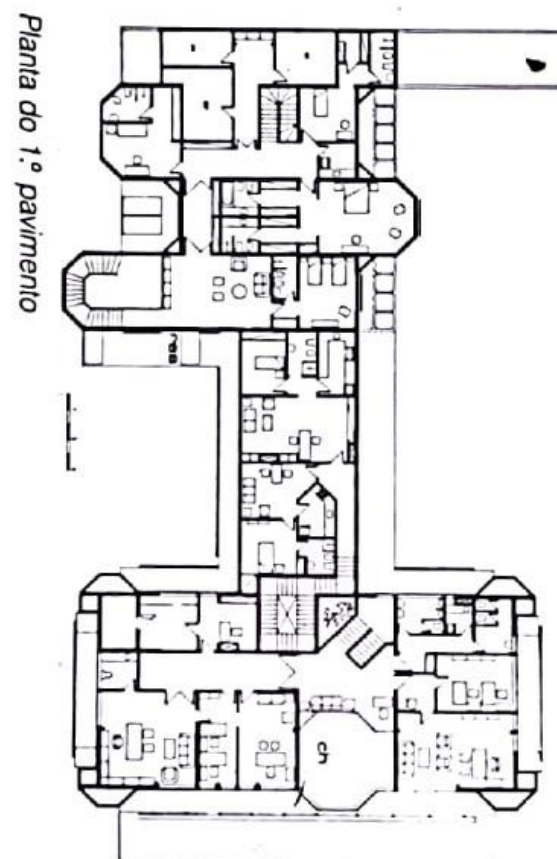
Planta baixa do primeiro pavimento dos edifícios da Chancelaria e da Residência Oficial. Fonte: Revista Projeto.
